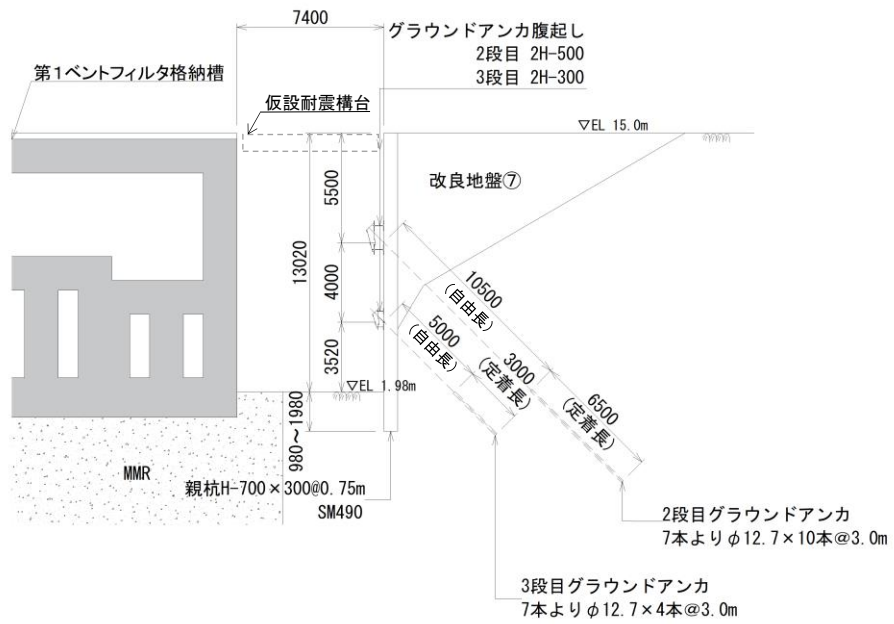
土留め工（親杭） 概略断面図（①-①' 断面）
